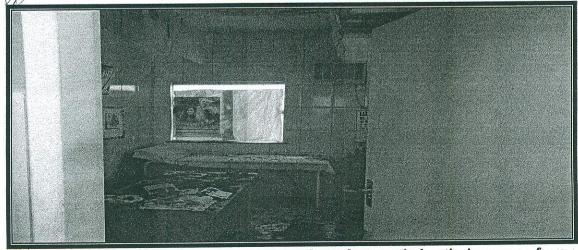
Sala Consultório Enfermaria: propagação descendente vertical – atingiu apenas o forro.
